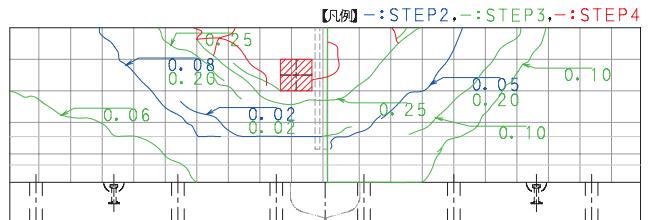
ひび割れ図(試験体B, 載荷STEP4)
